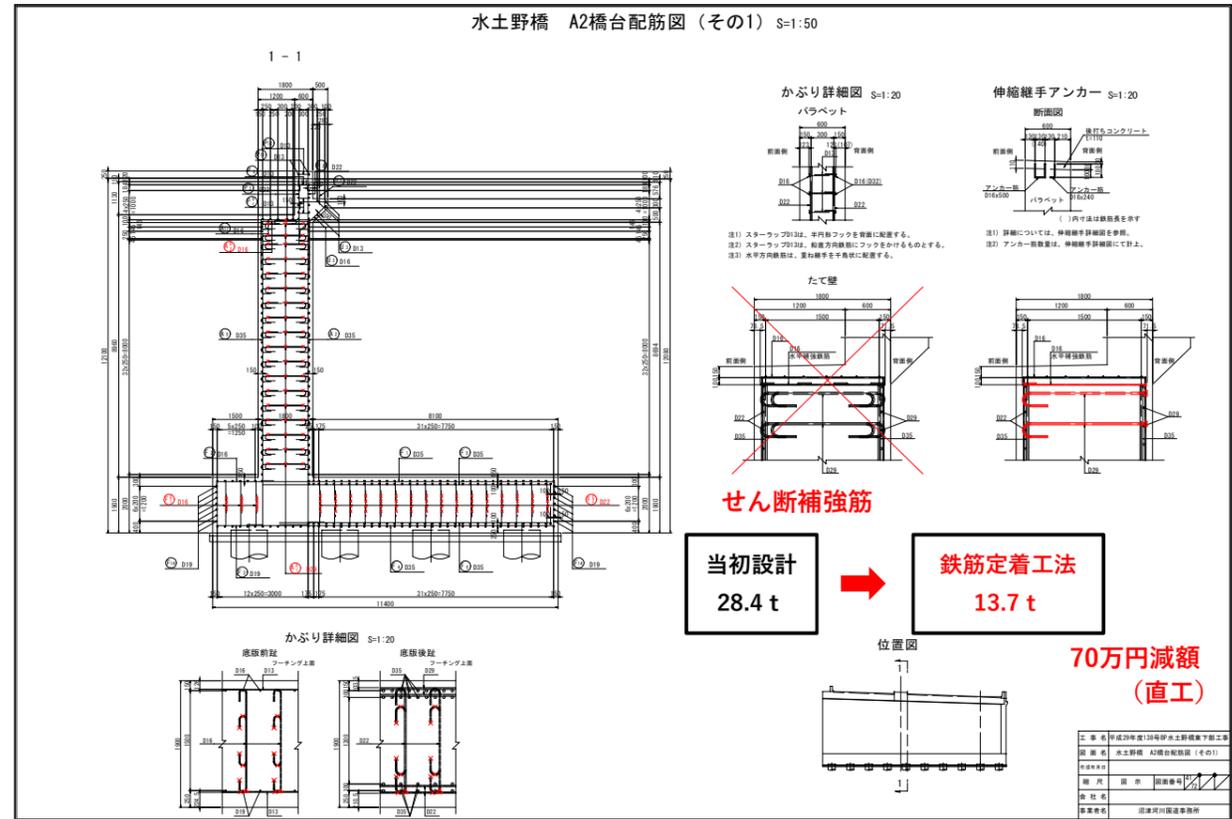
「Tヘッド工法鉄筋」と半円形フックおよび壁状構造物の配筋例
